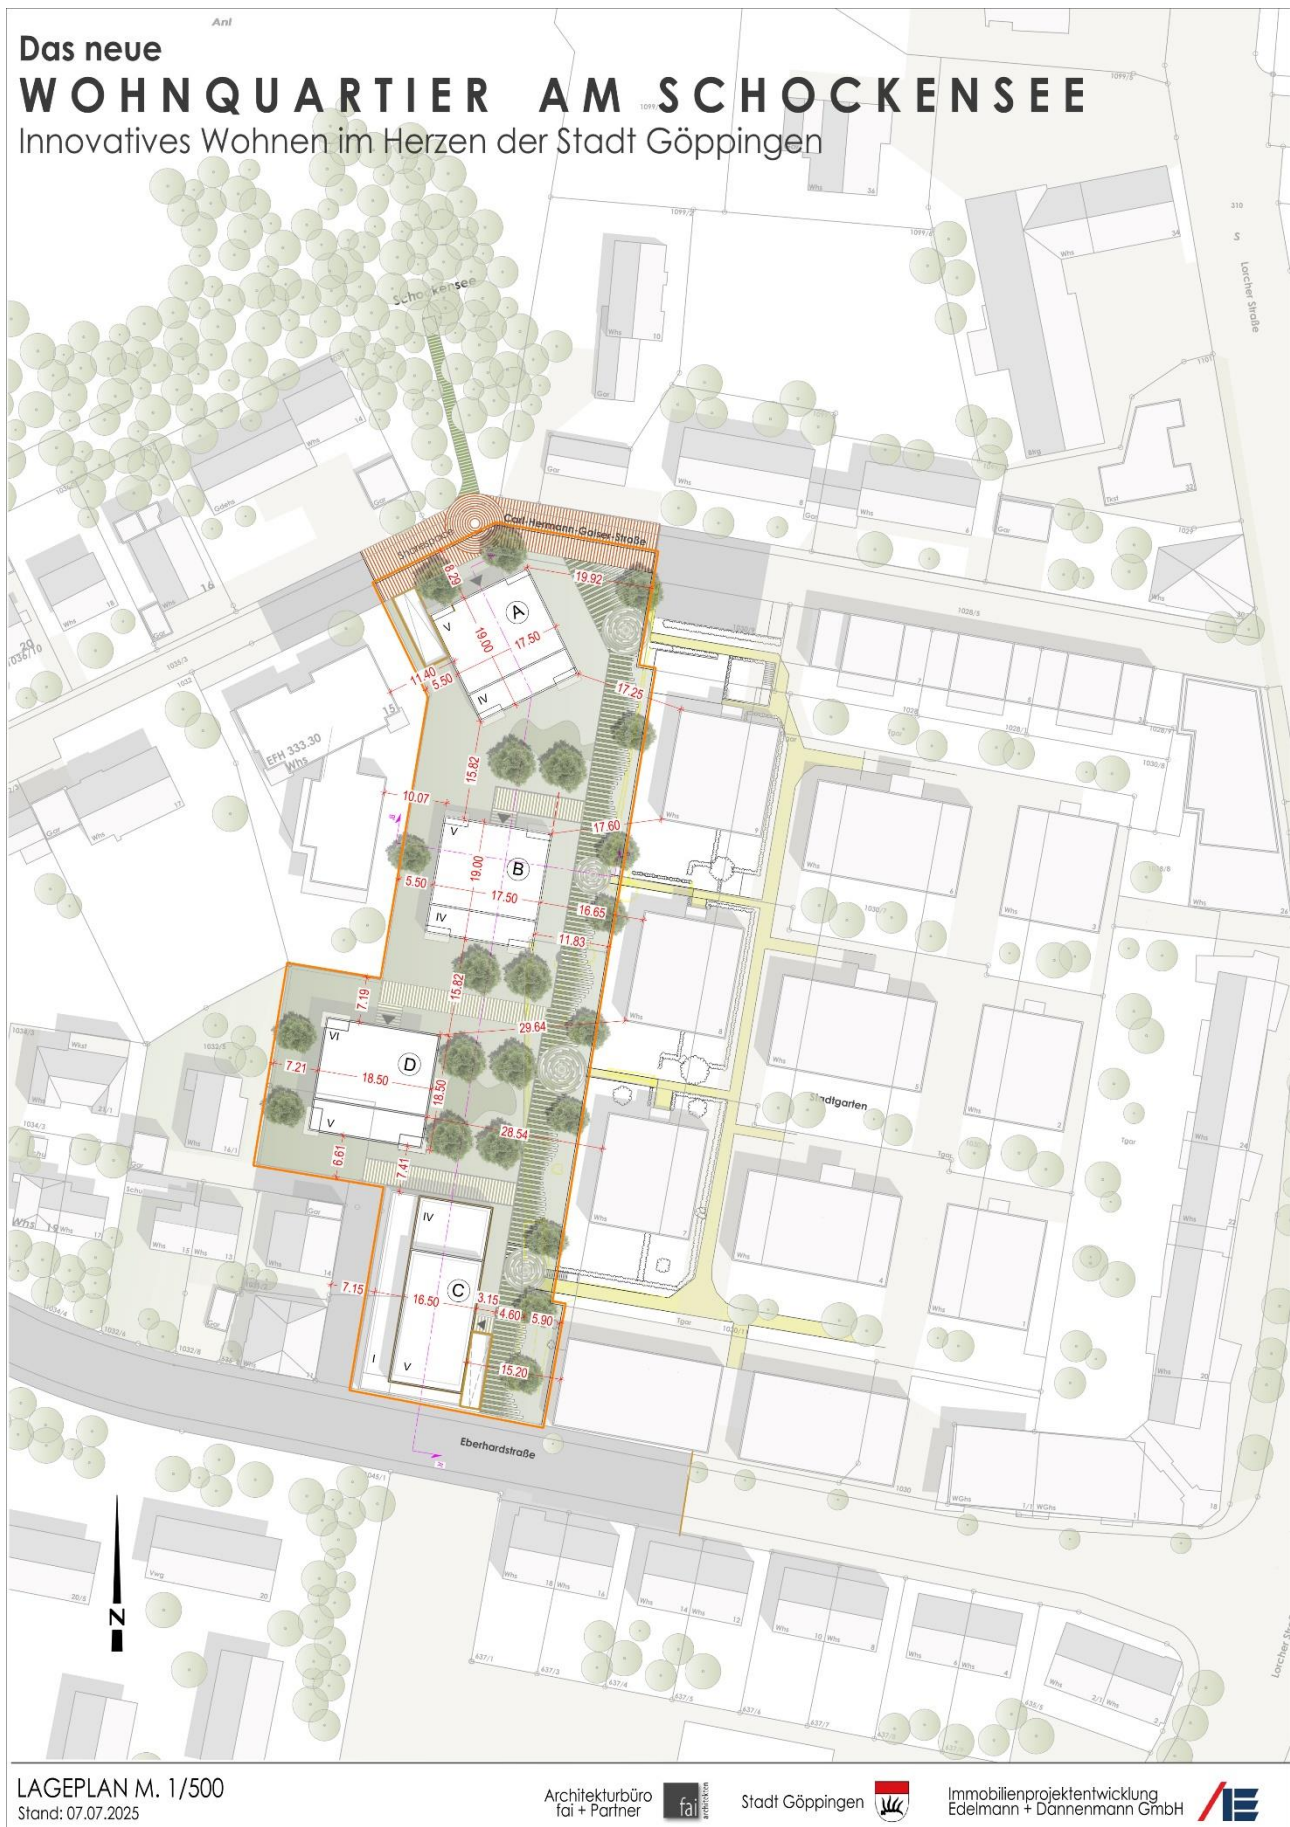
Plan des Bauvorhabens Frauenstraße – Aktualisierte Entwurfsvariante (Stand: 7.7.2025)
